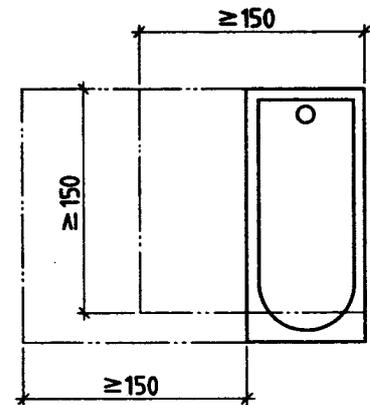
Bewegungsfläche Duschplatz; alternativ: Badewanne
